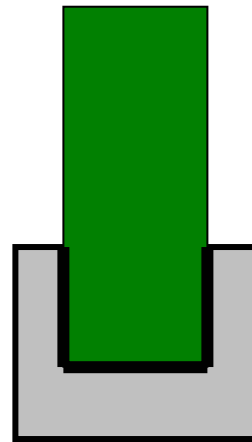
Conexión de pie-derechos al diafragma de cimentación
